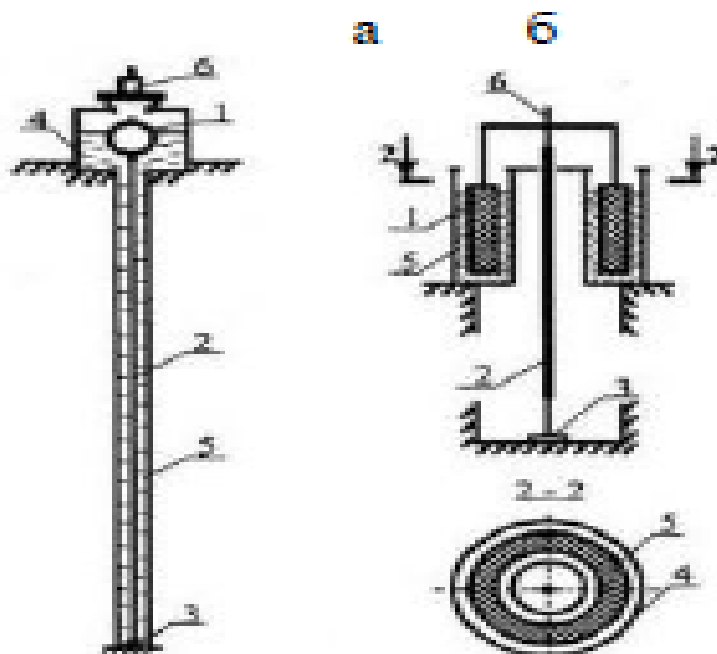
Конструктивная схема обратного отвеса: а - схема, требующая полкой герметизации и большого объема масла; б- усовершенствованная схема; 1- поплавок, 2- струна; 3 - марка; 4- корпус; 5- рабочая жидкость; 6- отсчетное устройство
